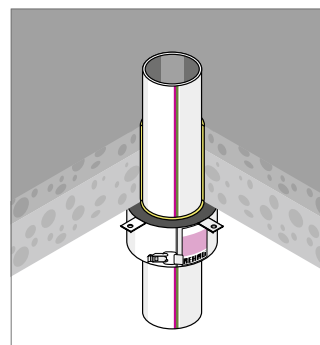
Противопожарная манжета для накладывания на перекрытие
